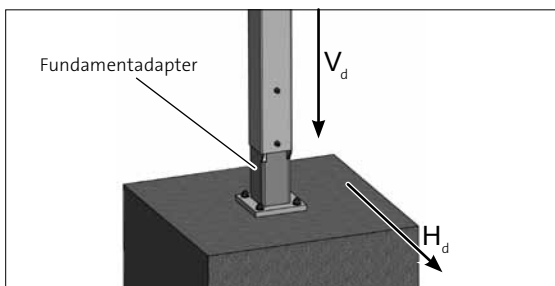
Fundamentadapter mit Fundament und Lasten
